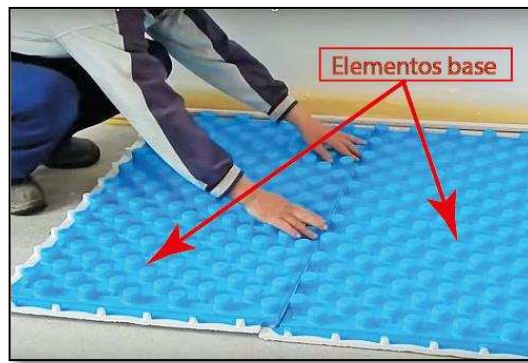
Esquema de Instalación: Capa de Aislamiento y Fijación de Tubos de Calefacción.
